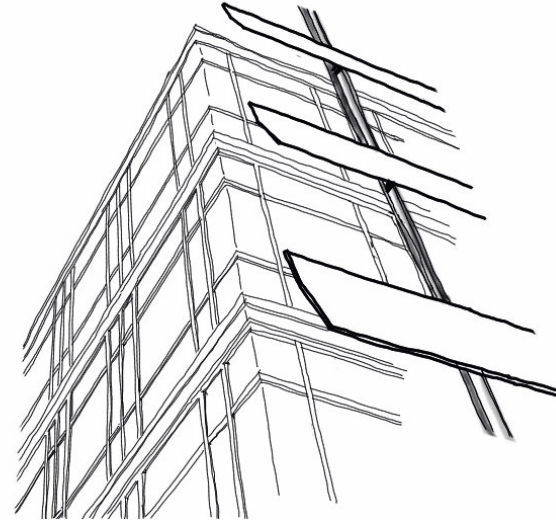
La fachada del edificio BCH es un tejido mientras que la fachada del museo es un muro sólido.
